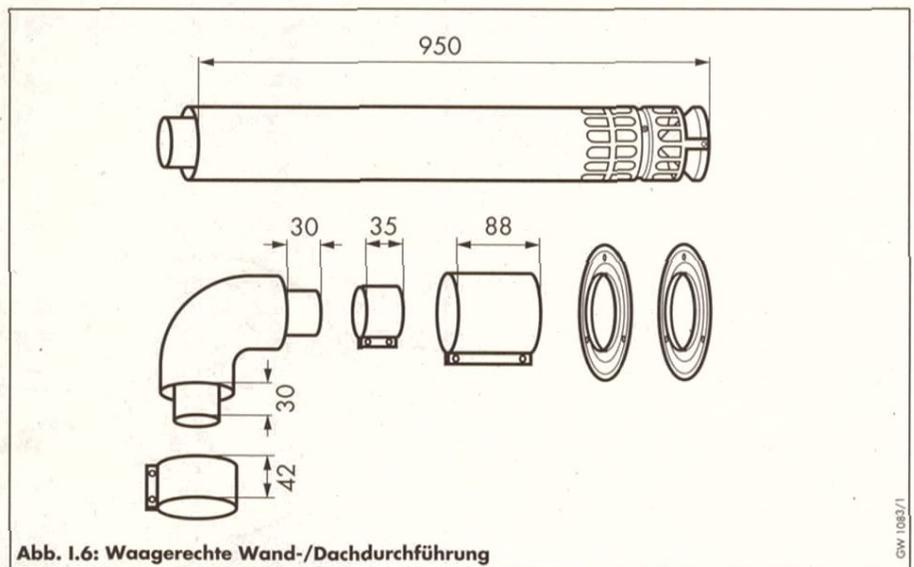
Waagerechte Wand-/Dachdurchführung
